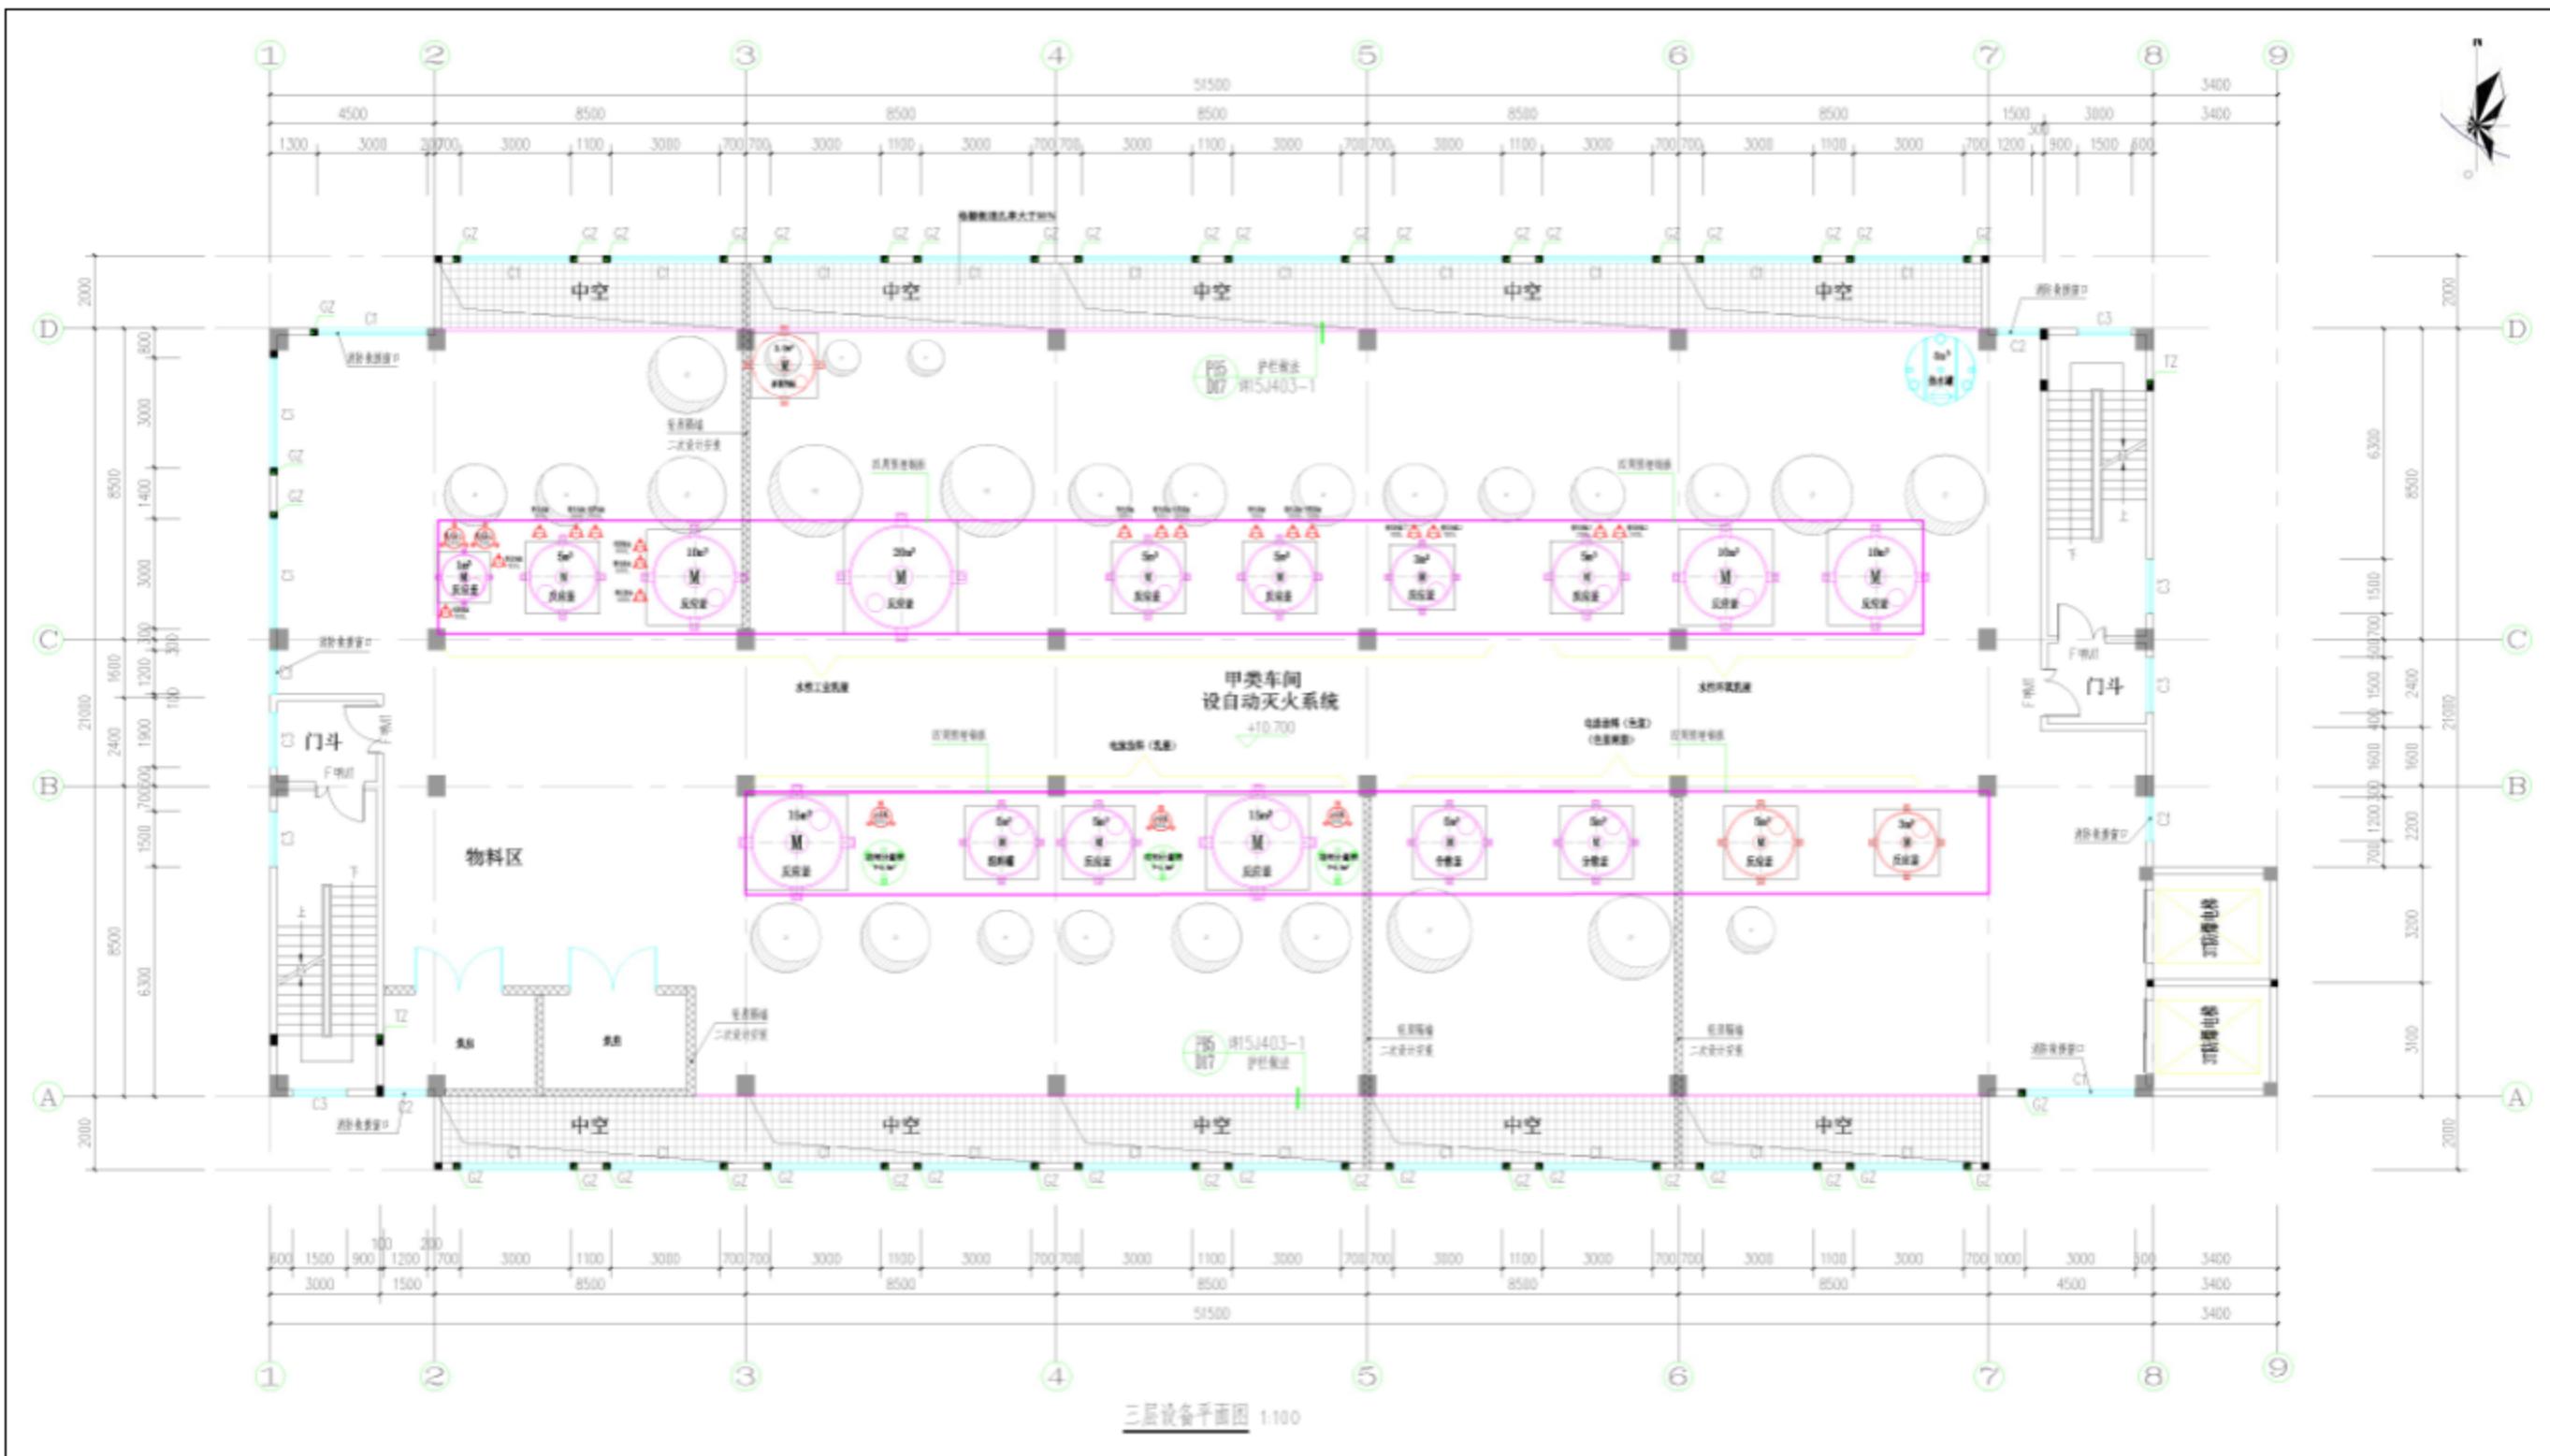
甲类车间C3层平面布置图(比例尺1:100)
